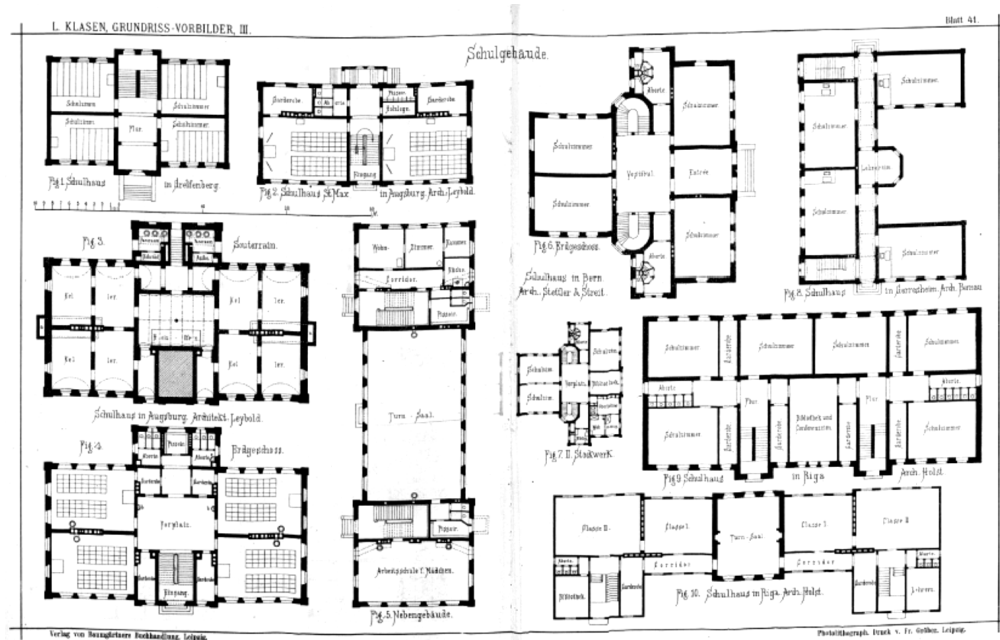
Grundriss-Vorbilder, Blatt 41 (Klassen 1884)²⁷
